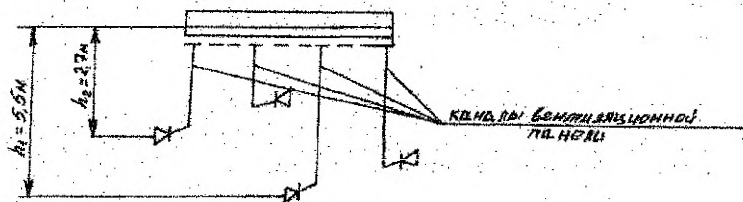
Схема вытяжной системы вентиляции с обособленными каналами.
